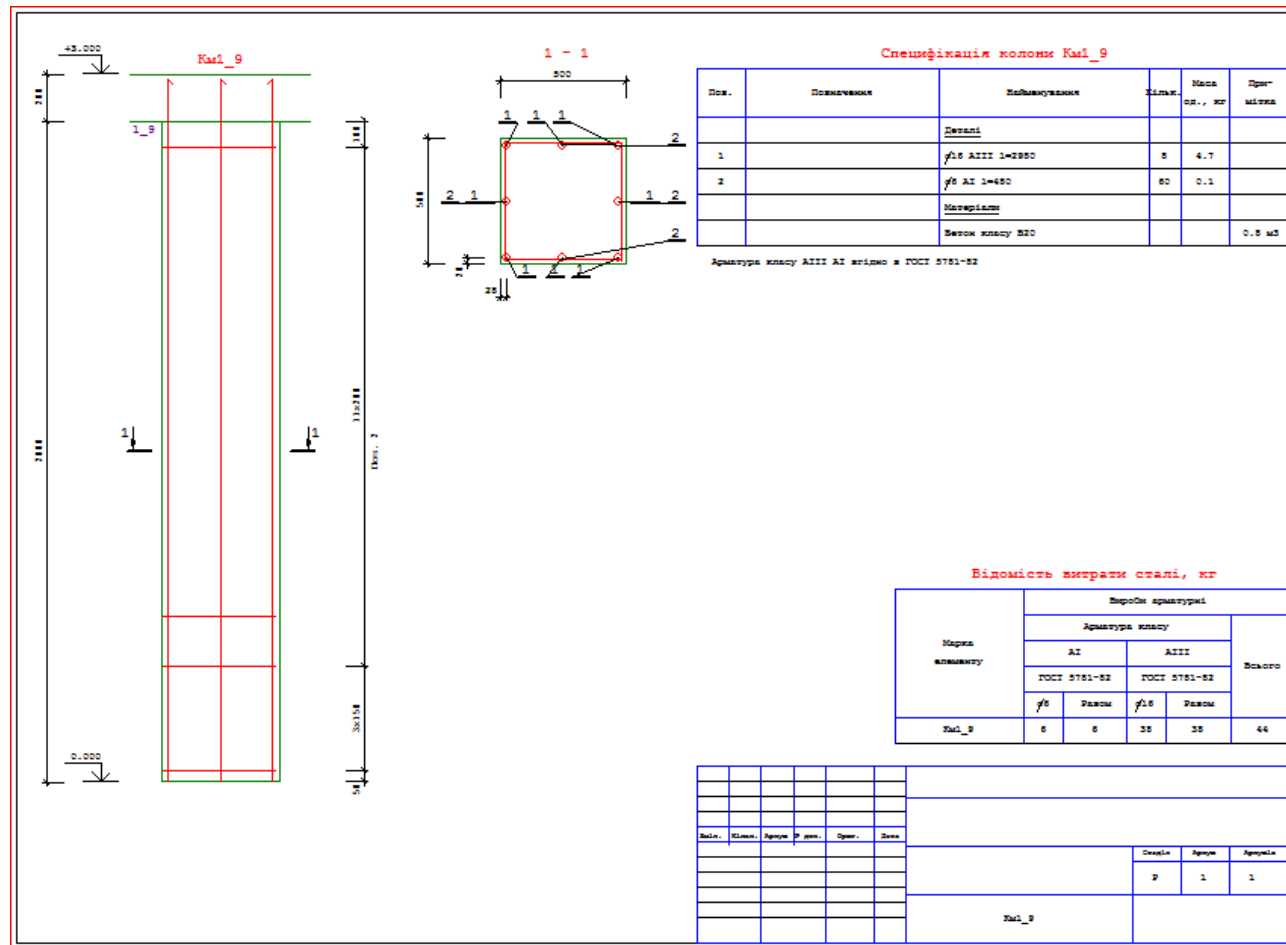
Варіант плитного перекриття. Колонна 1-9. Креслення робочого проекту
